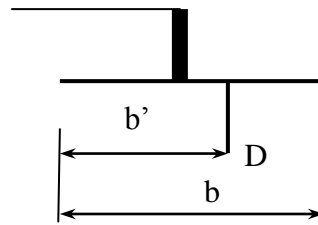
Lantai bendung dengan sheet pile
